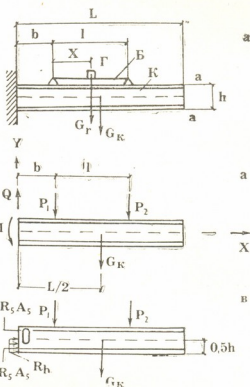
К примеру расчета максимального веса груза, воспринимаемого железобетонной консольной балкой без разрушения
